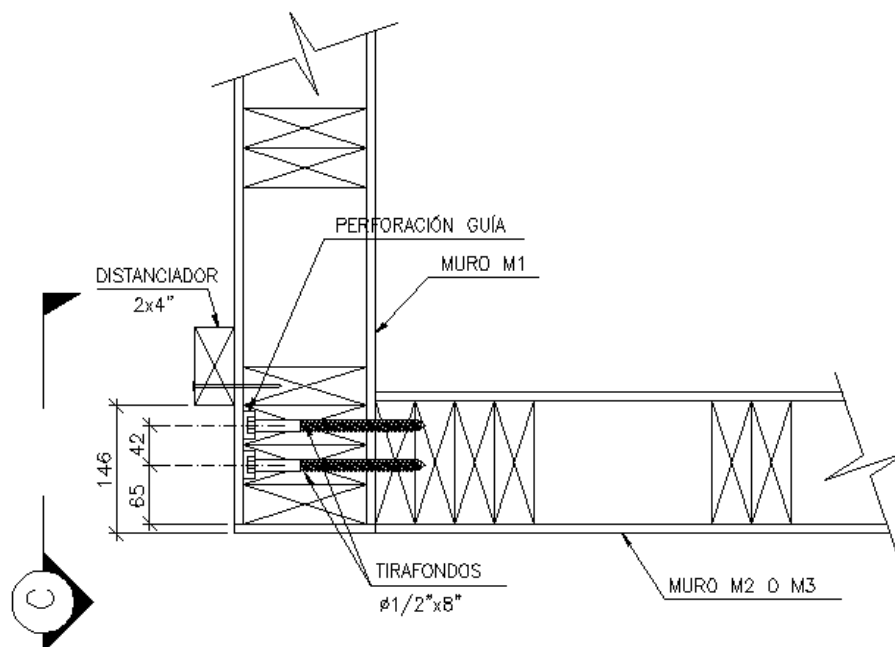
Detalle de conexión entre muros perimetrales longitudinal y transversal de Módulos en ensayo 3D (unidades en milímetros).
